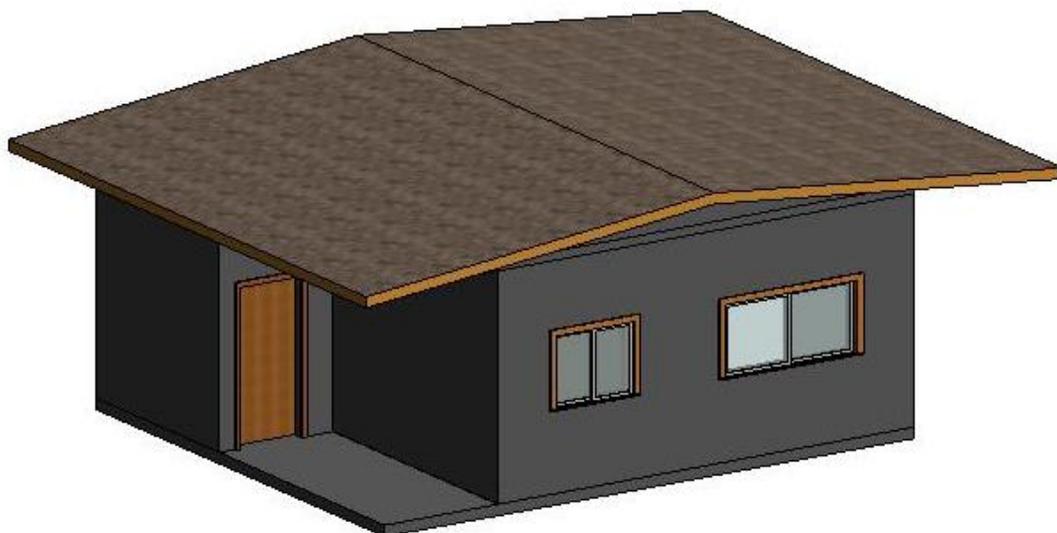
Construção do Telhado com o Fechamento das Empenas 01
